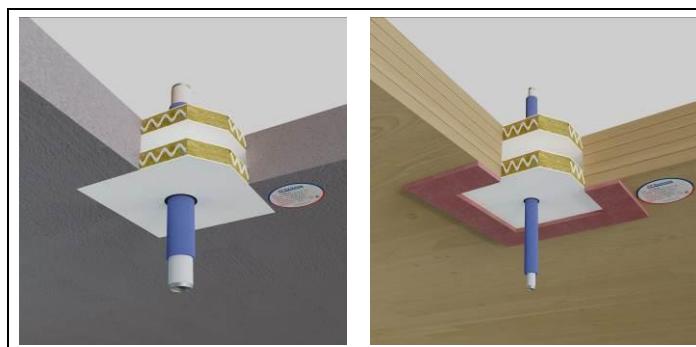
Exemple de joint de tuyaux composites multicouches dans les planchers.
